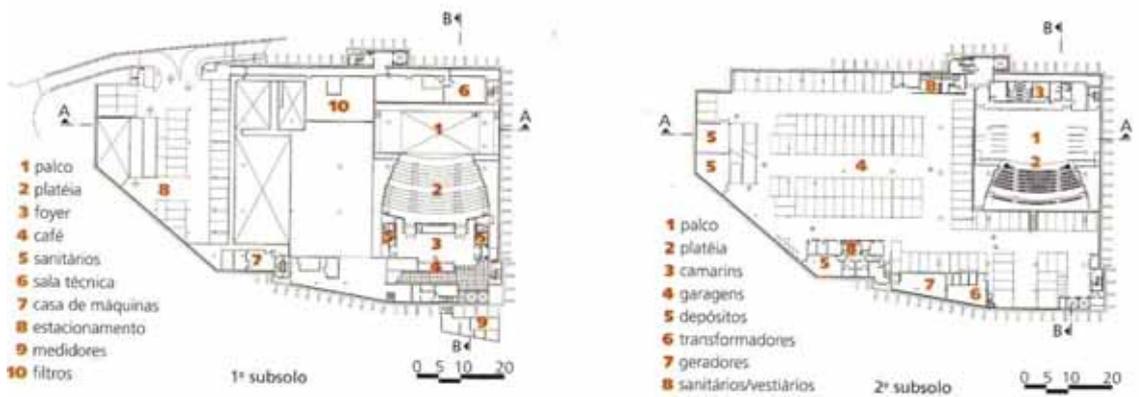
Plantas: 1º subsolo e 2º subsolo. Fonte: Leal (2005)
